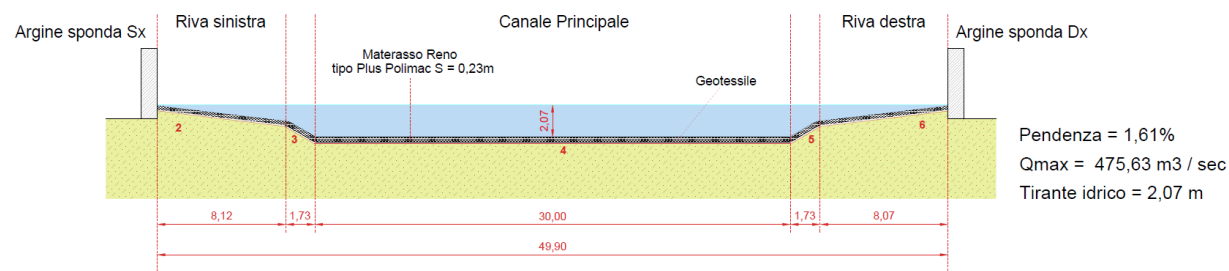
Progettazione dell'opera longitudinale nelle sezioni principali dei 4 tratti
